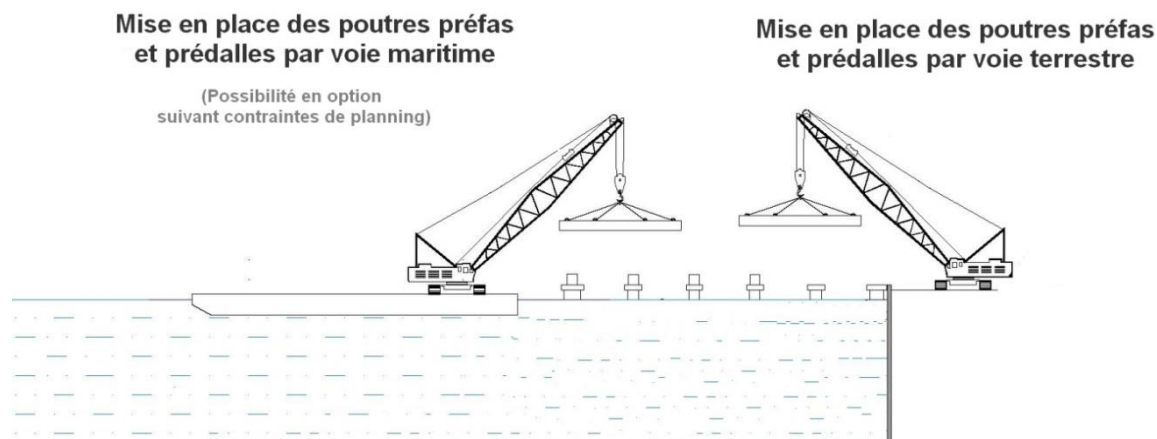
Mise en place des poutres préfabriquées et prédalles
